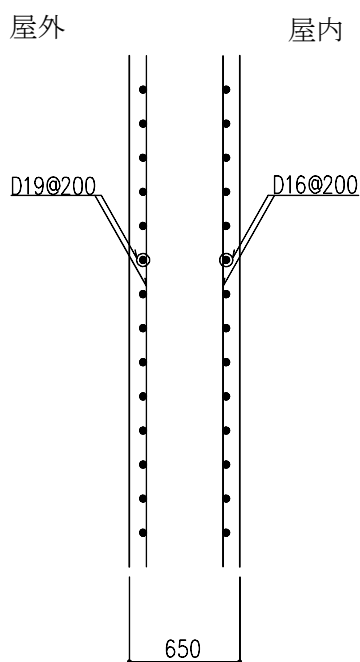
耐震壁の配筋図 (地下1階, YH通り X17~X18 通り間) (単位: mm)
